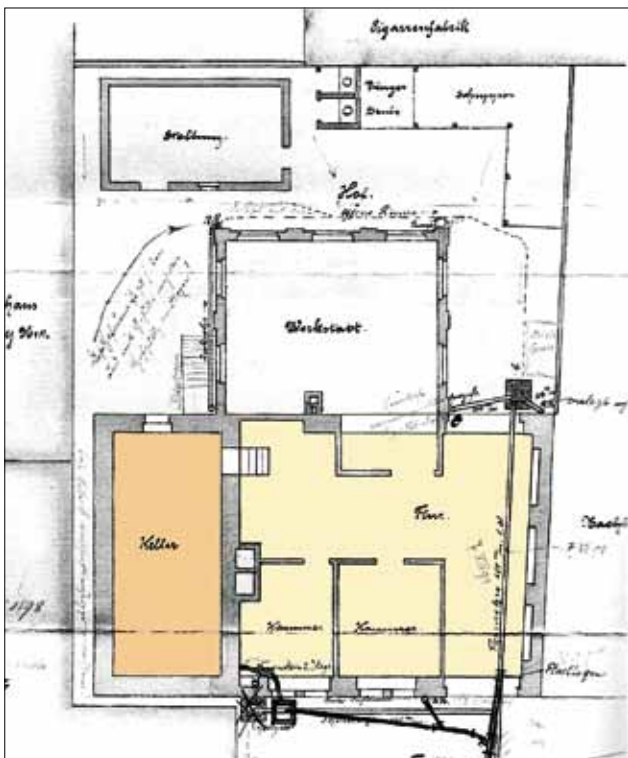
Göttingen. Grundriss des Städtischen Museums („Hardenberger Hof“).
